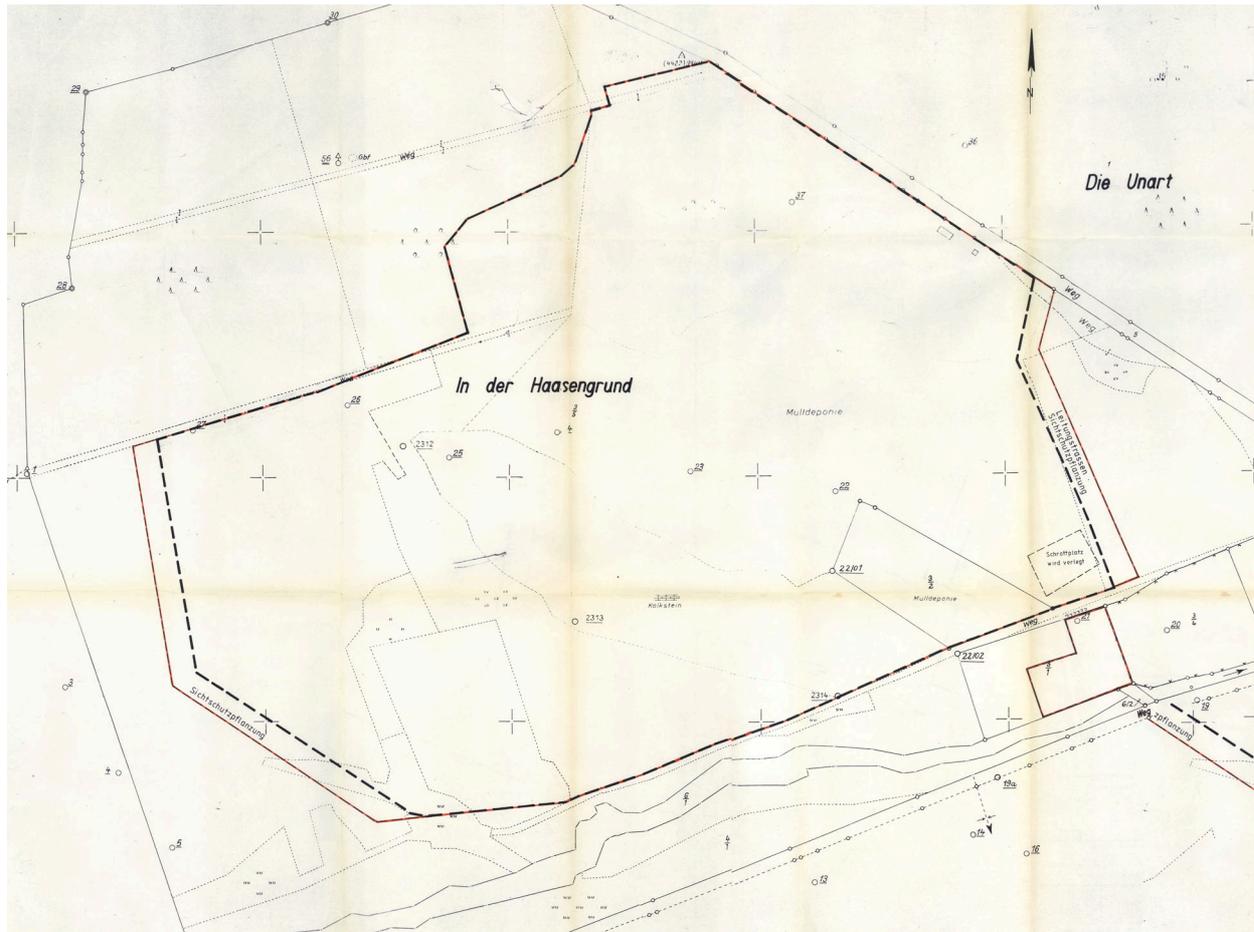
Lageplan inklusive Geltungsbereich zur Erweiterung der Deponieflächen gemäß Planfeststellungsbeschluss (Quelle: Geolog. und Ing. Büro Dr. Pickel, 31.10.1987, ohne Maßstab)
